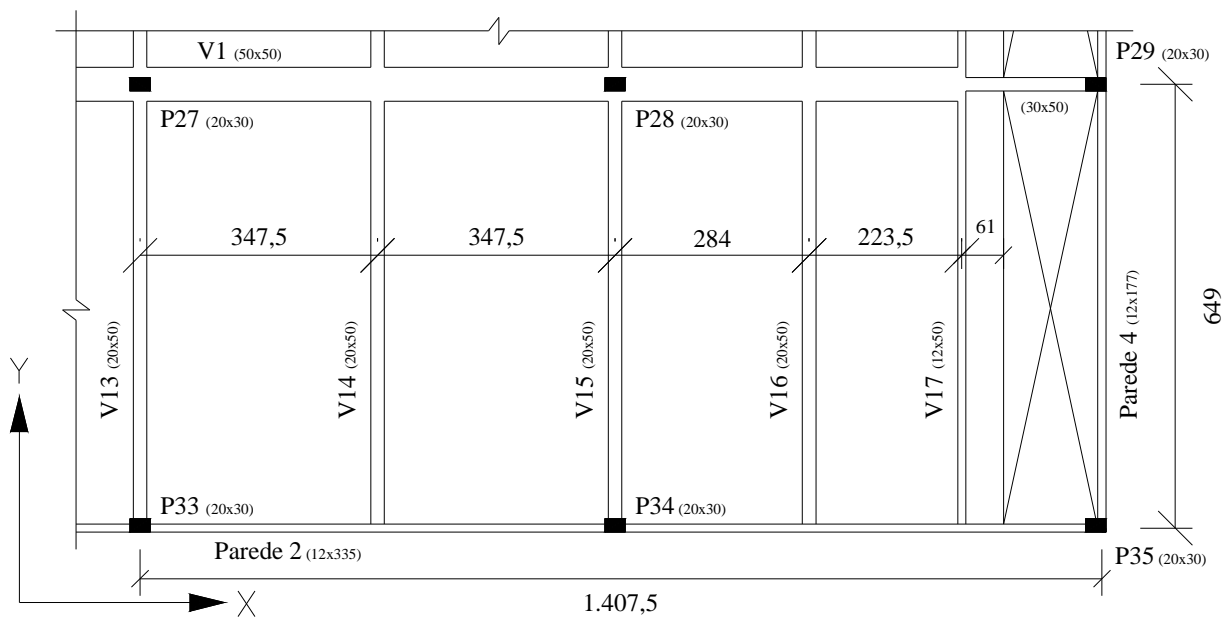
Detalhe do trecho da laje analisado (dimensões em centímetros).
